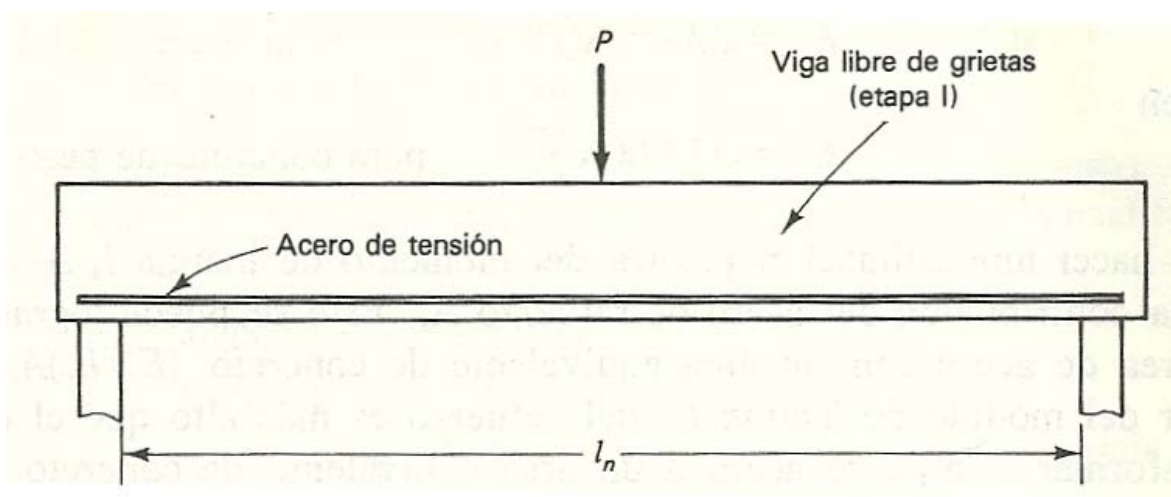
Viga con carga en la etapa anterior al agrietamiento
